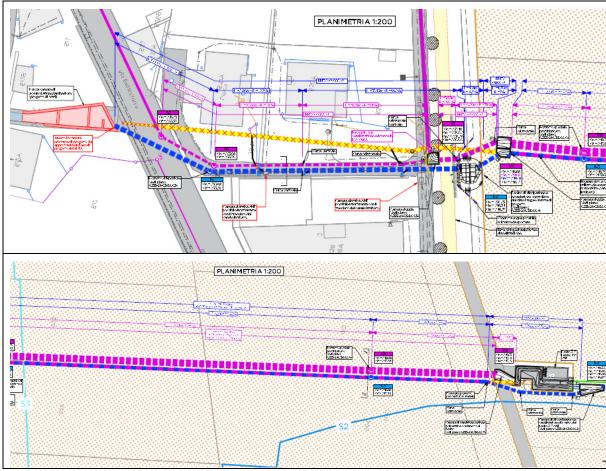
Planimetria degli interventi previsti nel progetto definitivo.
